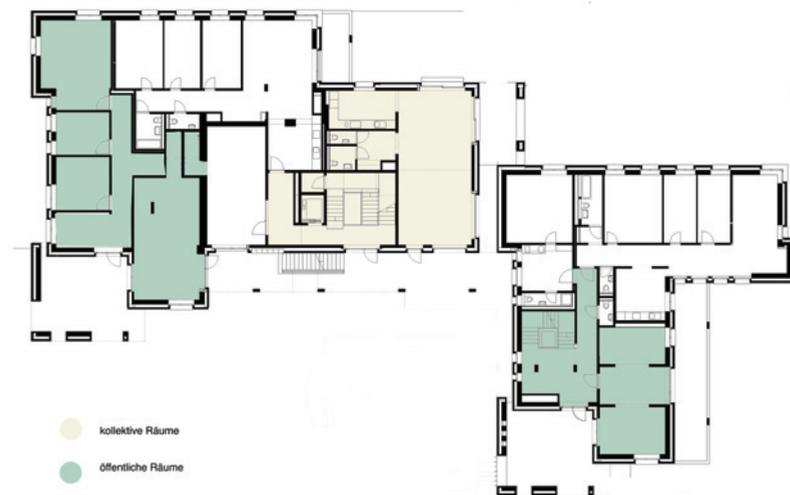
Grundriss Heizenholz, Adrian Streich Architekten, M 1:100
